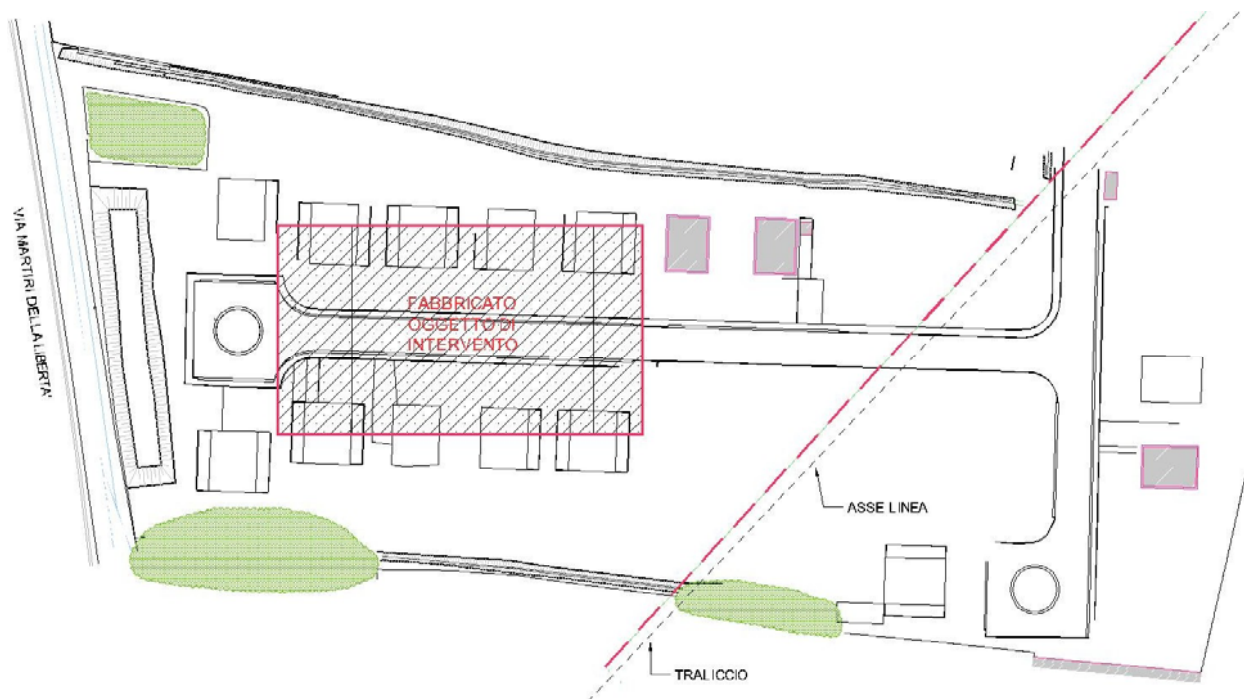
planimetria rilevata con indicazione del traliccio esistente e del fabbricato di progetto
